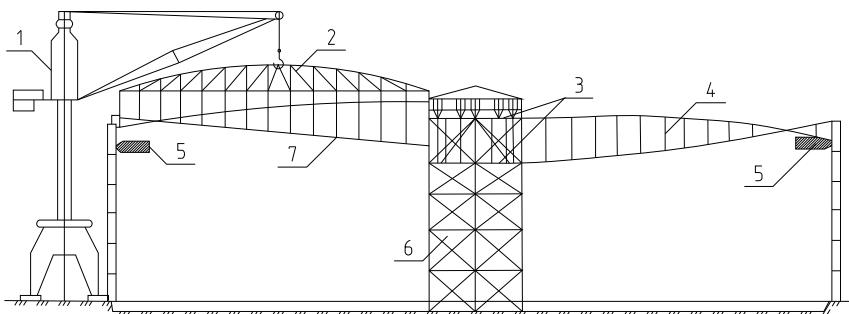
Технологическая схема перекрытия вантовыми фермами:
